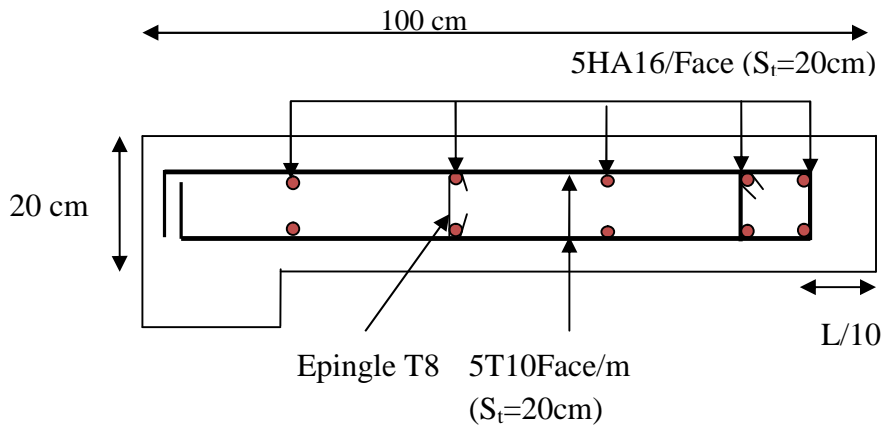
Schéma de ferrailage du voile Vx1 du niveau 1
